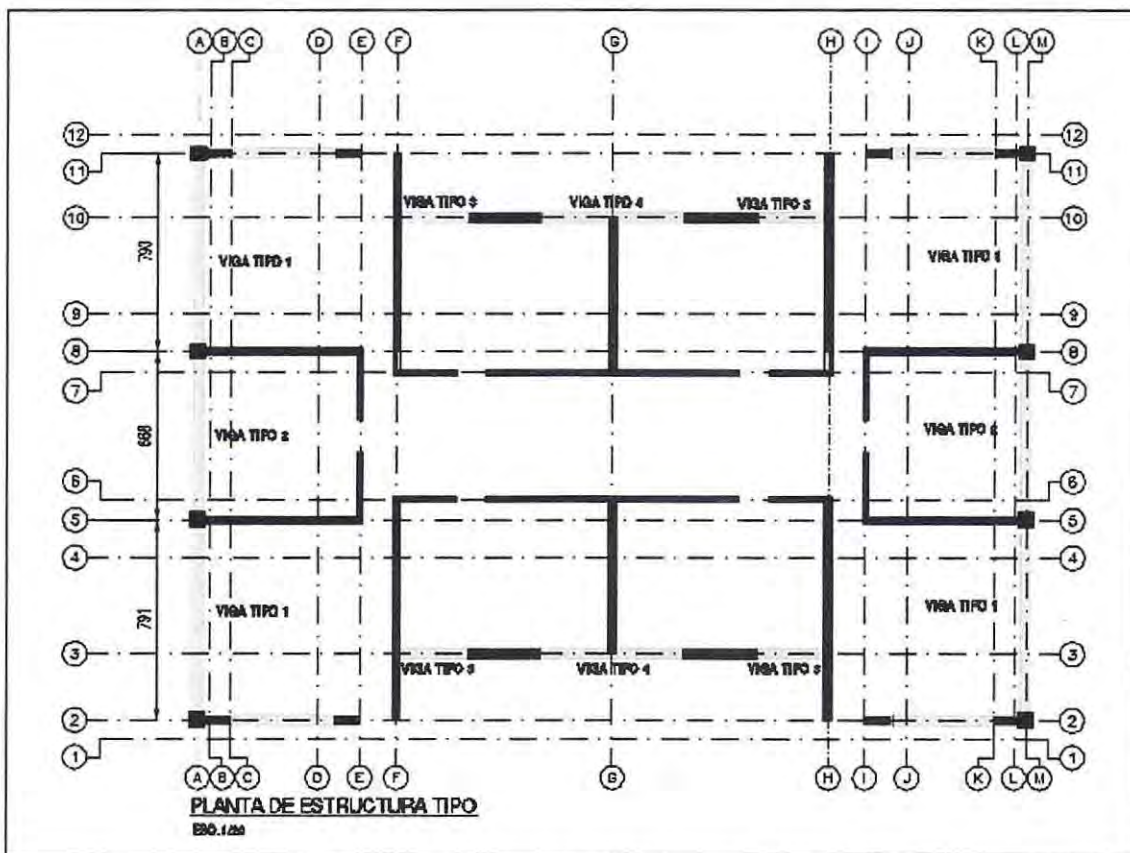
Distribución en planta tipos de vigas para ambos edificios
